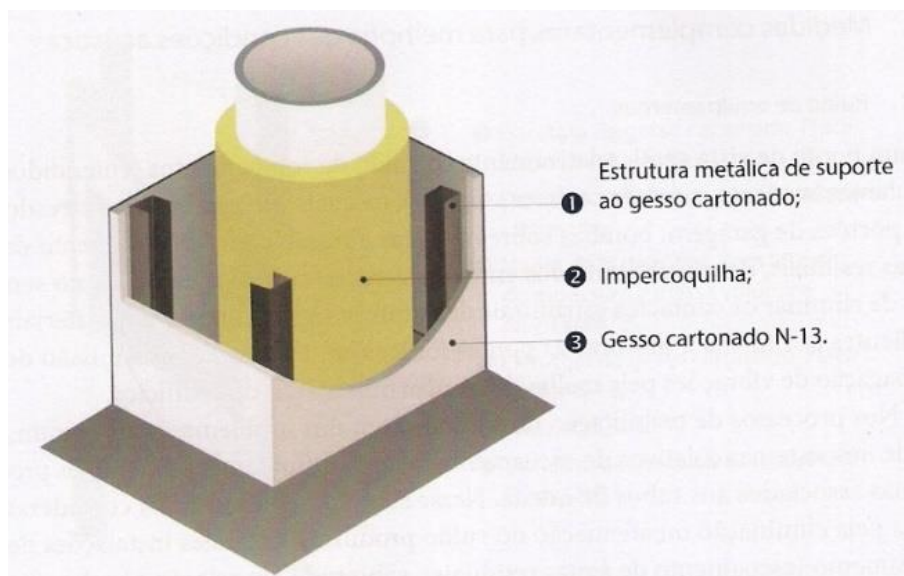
Proteção de instalações de drenagem e abastecimento de águas [38]
